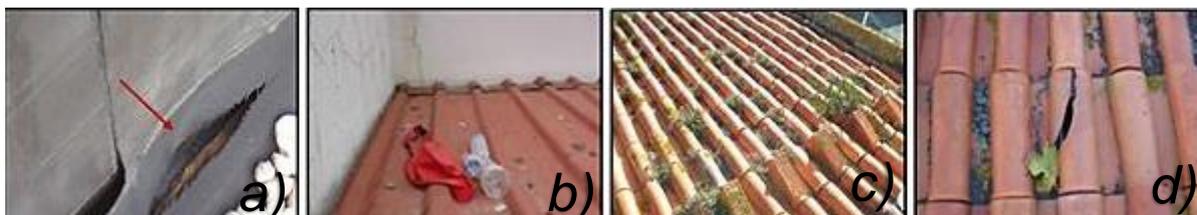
Representação de anomalias em coberturas em terraço (Ginga, 2008) e inclinadas (Garcez, 2009): a) Fissuração no revestimento impermeabilizante de uma cobertura em terraço b) Detritos em coberturas inclinadas; c) Vegetação parasitária em cobertura inclinada; d) Fissuração em revestimento cerâmico de cobertura inclinada.
